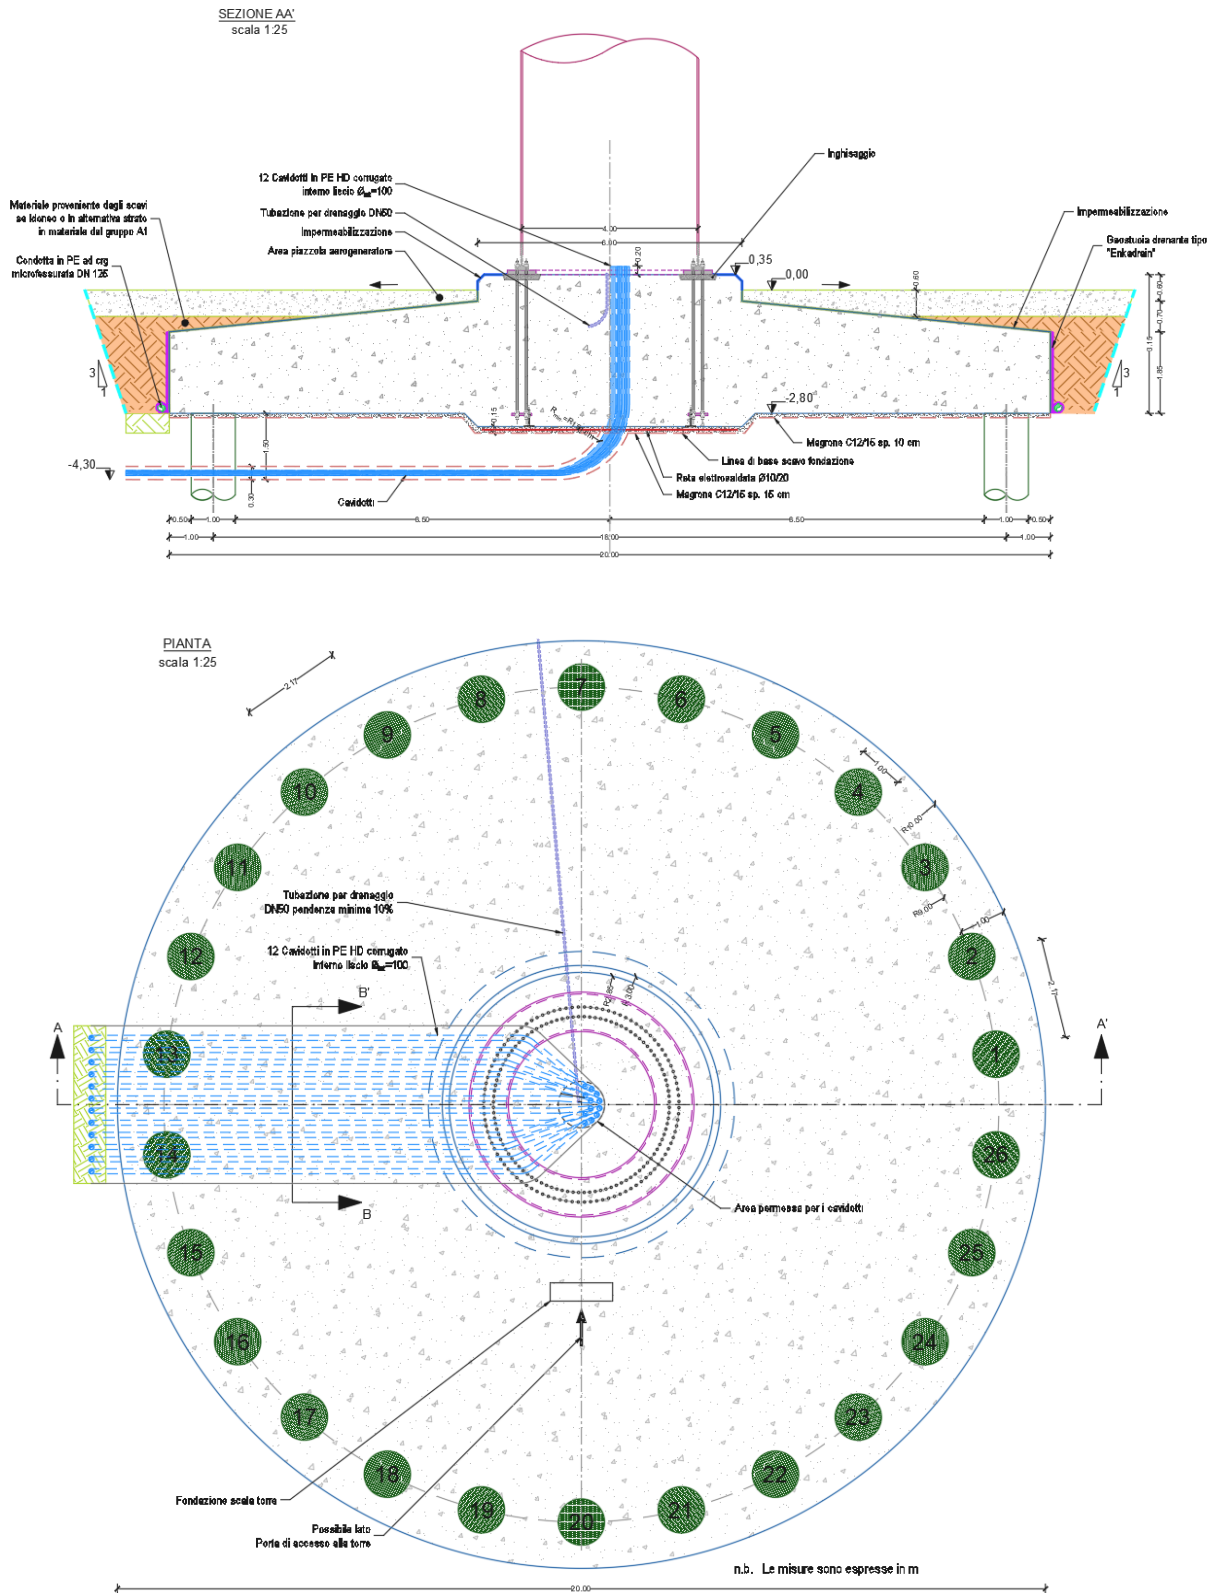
Pianta e sezione del pinto su pali - diametro fondazione 20,00 m
